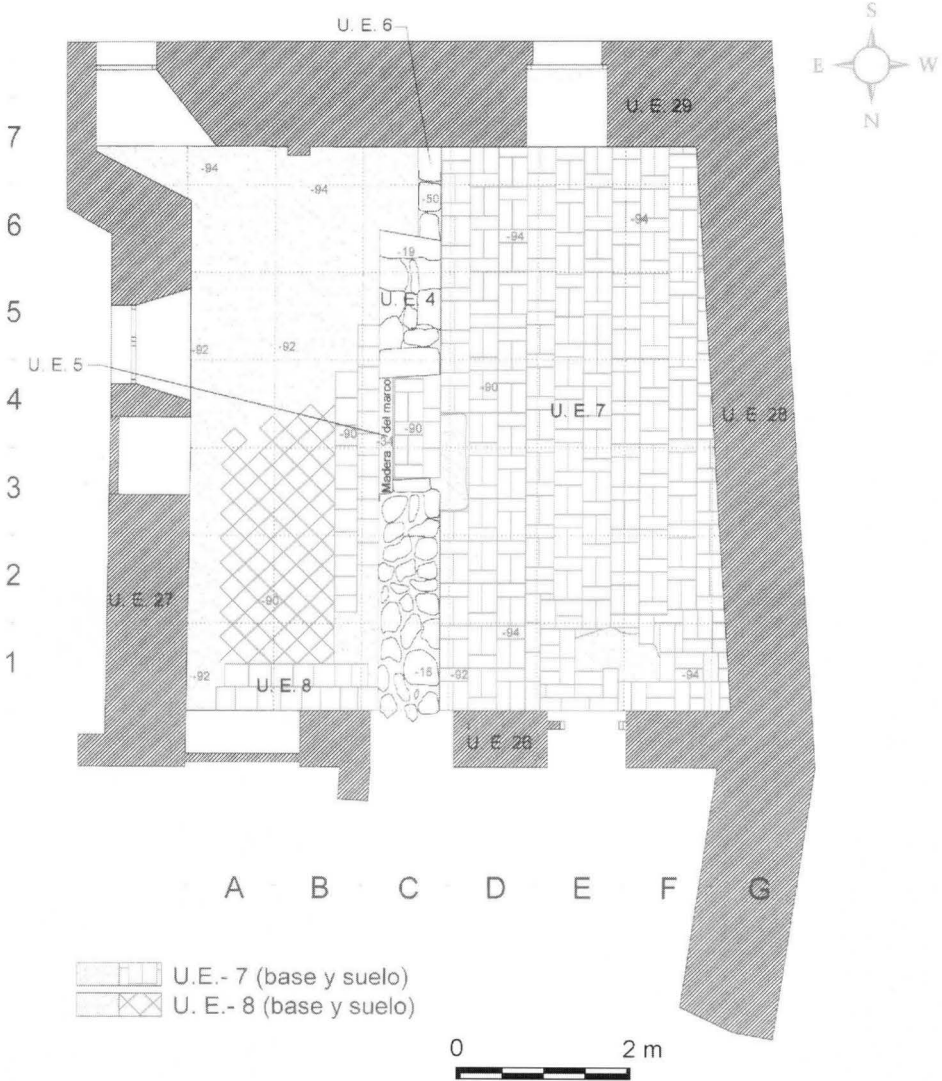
Planta de pavimentos reconocidos en la excavación.
